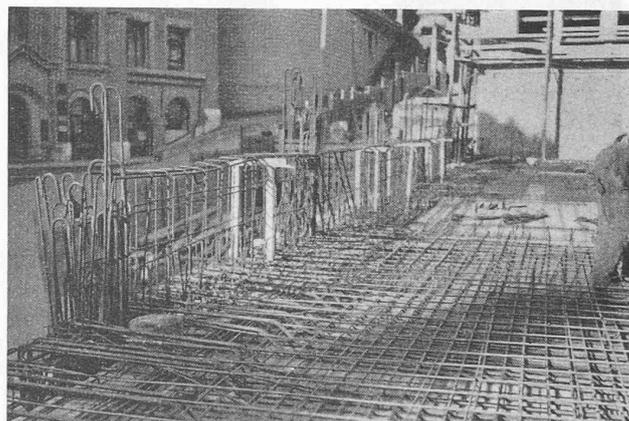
Détail de l'armature de la dalle et des piliers (attente).
